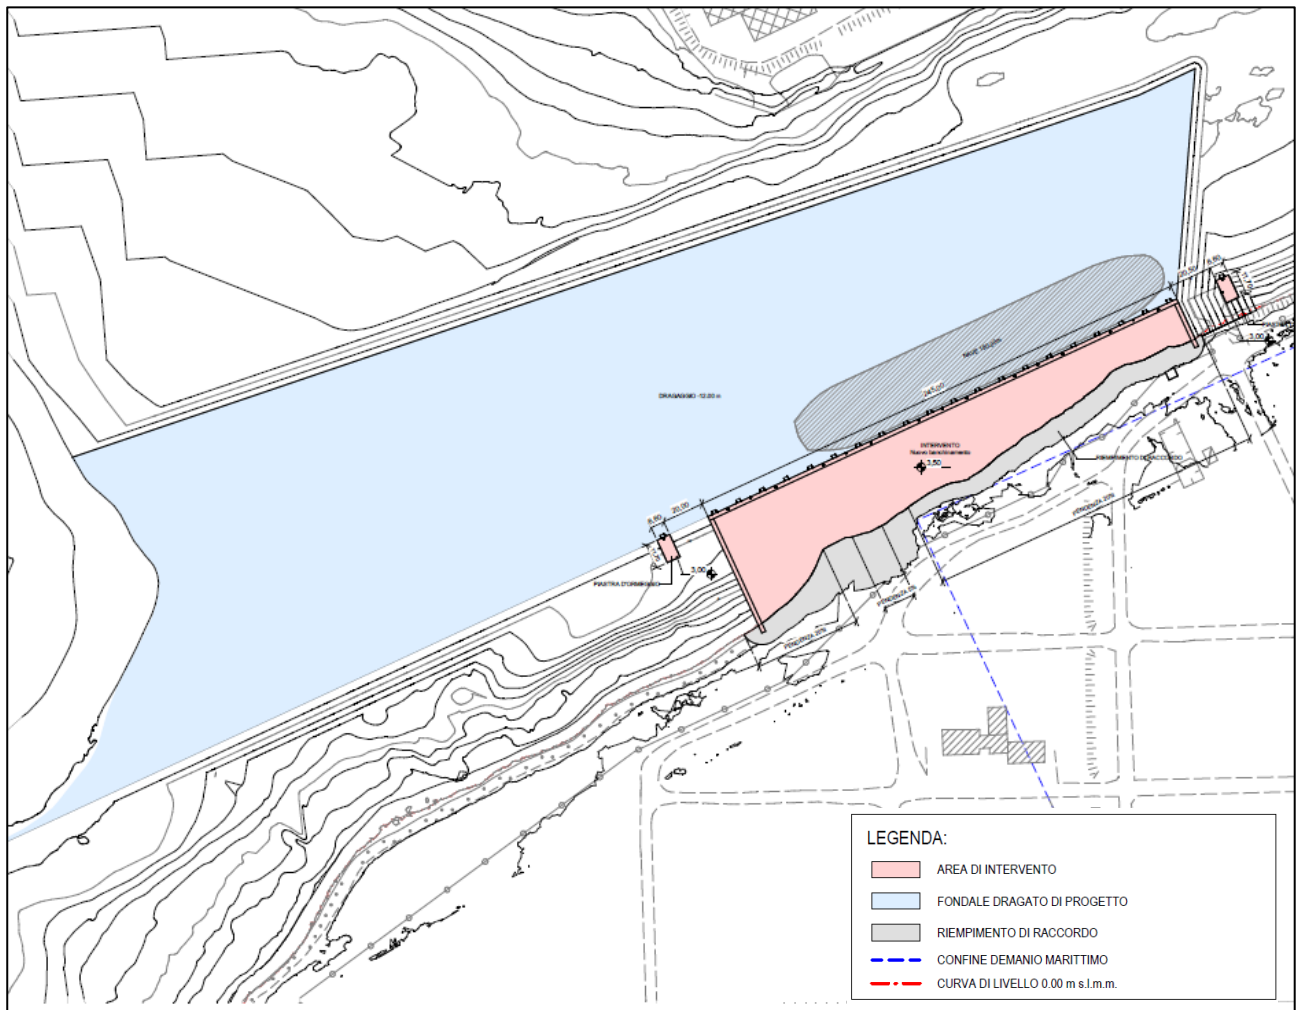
Planimetria Lotto 1a oggetto del presente appalto
